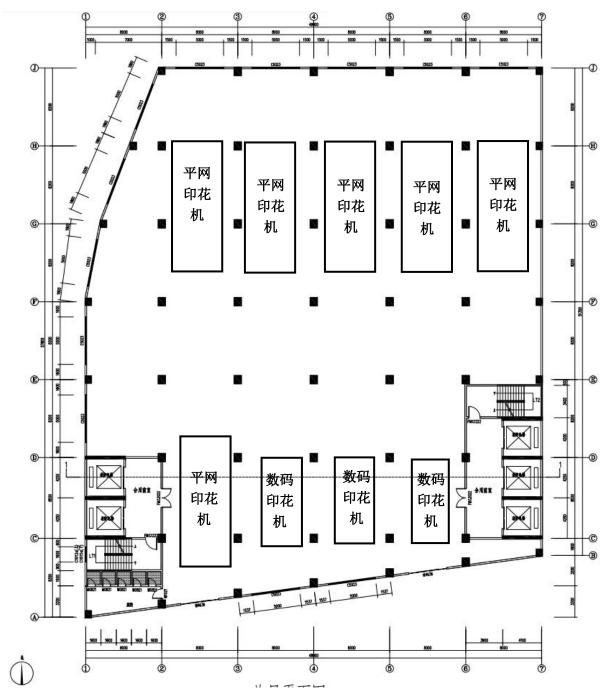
原有项目(B 栋厂房)6 楼平面布置图
